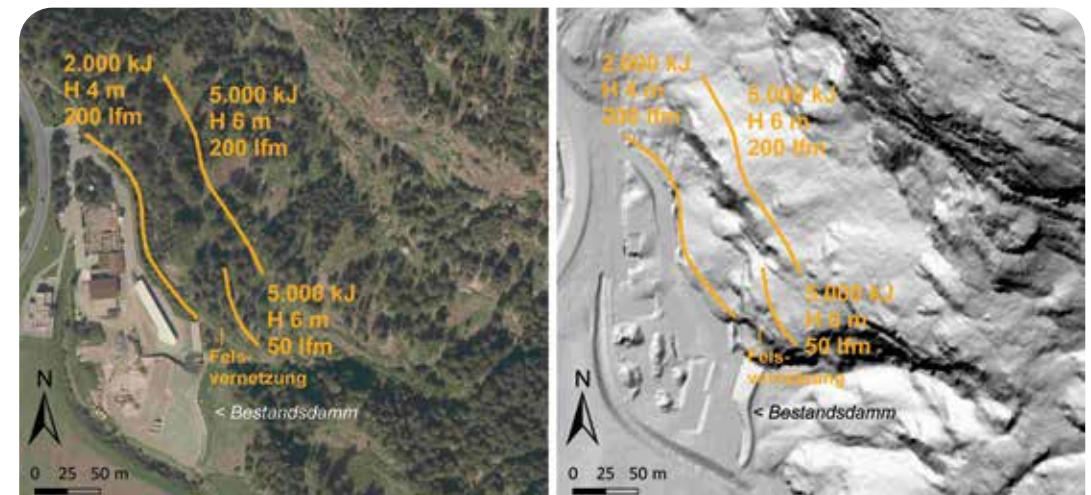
Situation im Lageplan (Orthofoto und LIDAR-Geländemodell) mit dem Verbaunungskonzept nach Sausgruber (2015).
